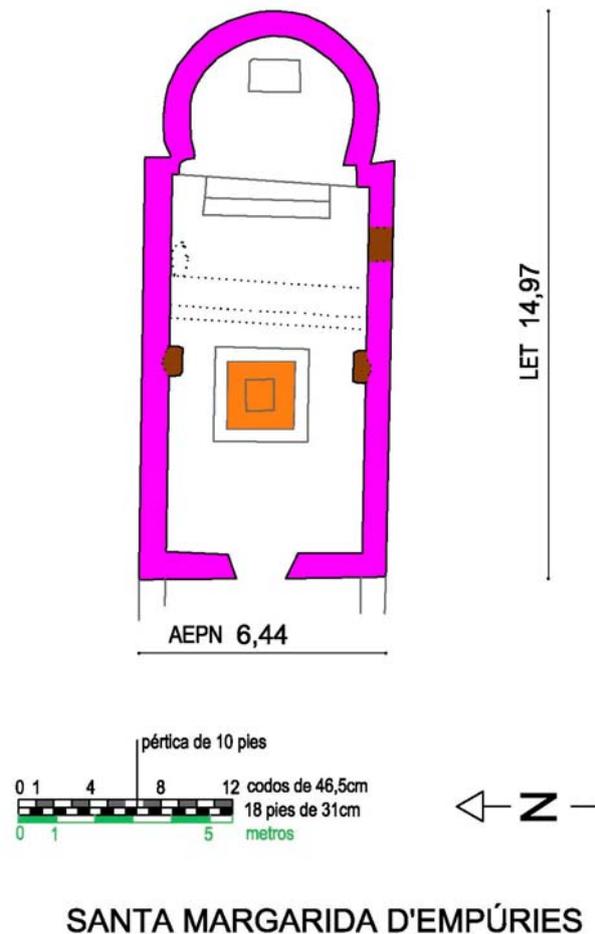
Planta crono-cromática de Sta. Margarida. Elaborada por autora.
